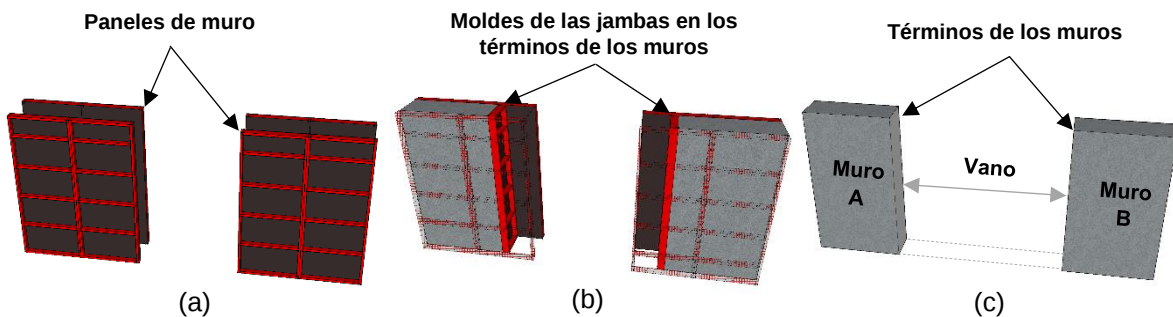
Proceso constructivo de vanos en términos de muro: (a) paneles de dos muros coplanares; (b) molde de las jambas como tapas del moldaje; (c) vano entre dos muros o secciones de muro
